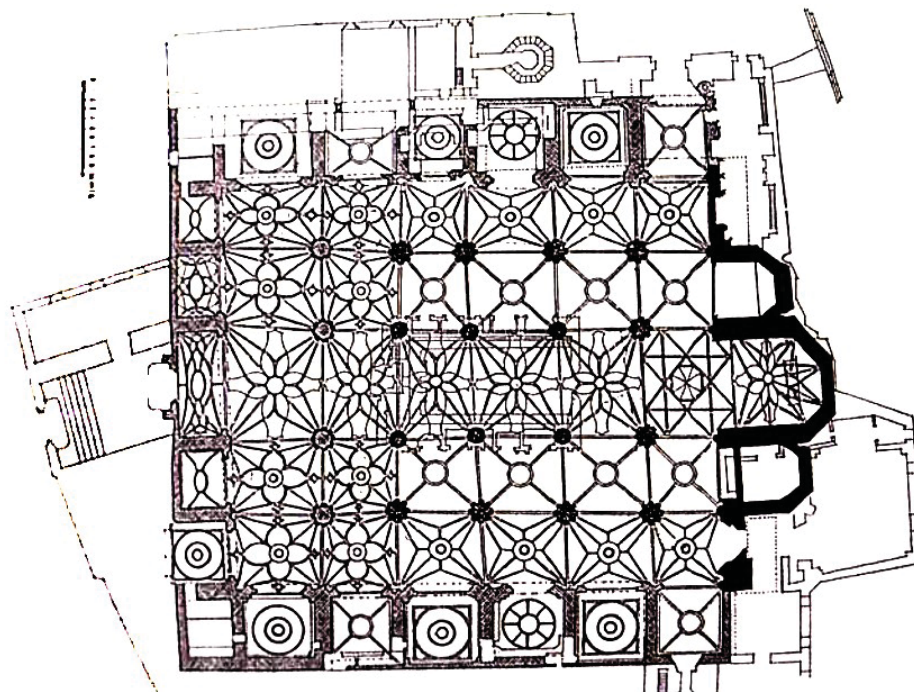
Planta de La Seo de Zaragoza según F. Chueca Goitia
